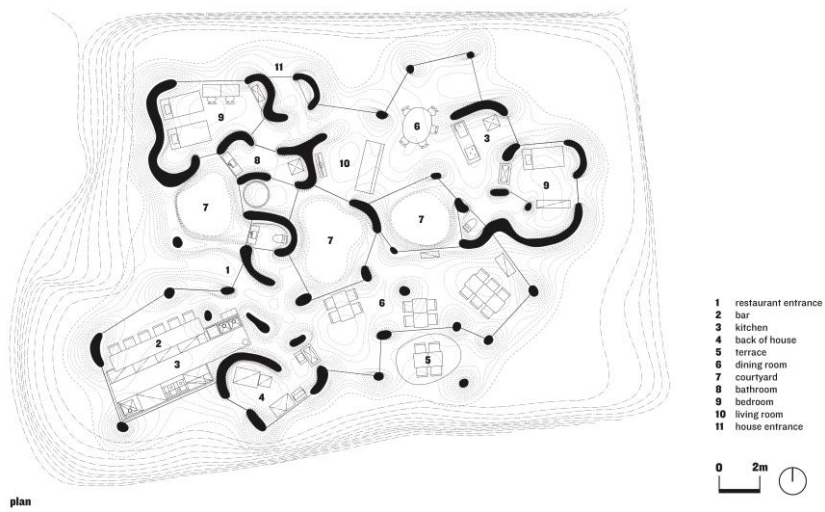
Planta del proyecto Casa & Restaurante. Arquitectos: Junya Ishigami + associates. UBE. Japón.
